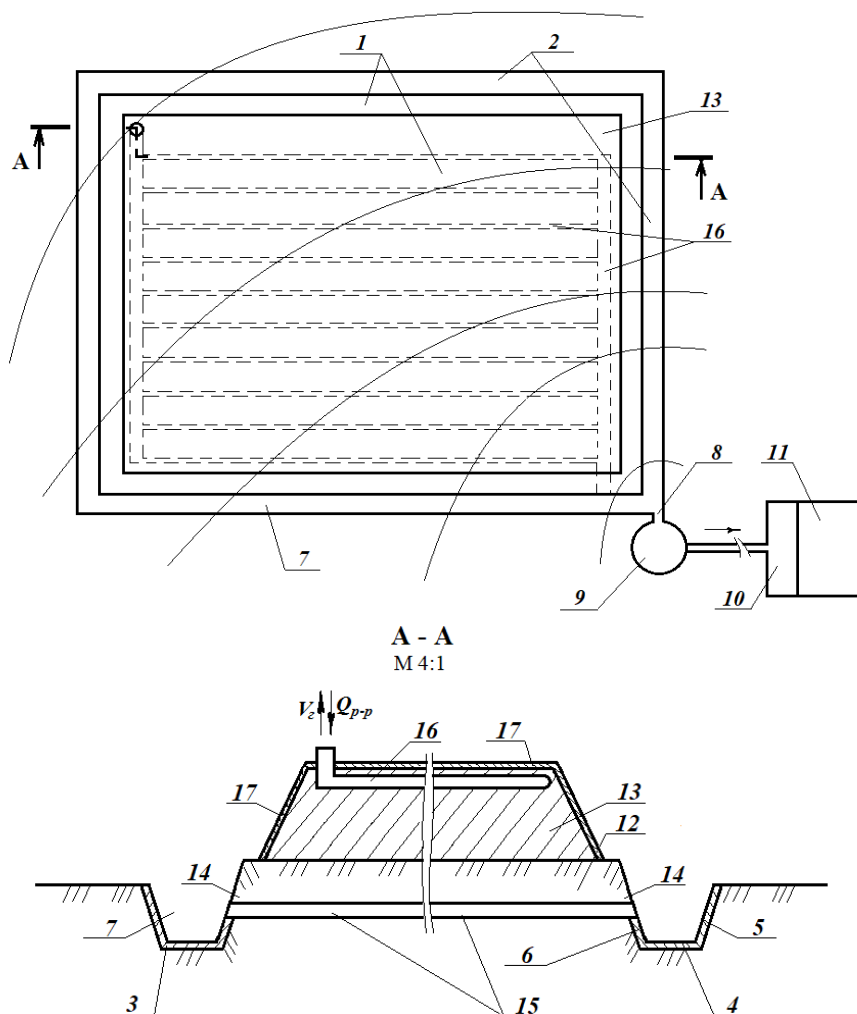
Конструкция полигона ТКО, реконструированного из несанкционированной свалки: 1 – свалочное тело; 2 – кольцевой дренаж открытого типа; 3 – гидроизоляция; 4 – дно дренажной траншеи; 5 – внешний склон дренажной траншеи; 6 – нижняя часть внутреннего склона дренажной траншеи; 7 – дренажная траншея; 8 – место соединения дренажной траншеи с водосборным колодцем; 9 – водосборный колодец; 10 – накопительная емкость; 11 – станция водоочистки; 12 – основание полигона; 13 – строение полигона; 14 – верхняя часть внутренней стенки дренажной траншеи; 15 – горизонтальная скважина; 16 – перфорированный трубопровод; 17 – насыпной грунт
